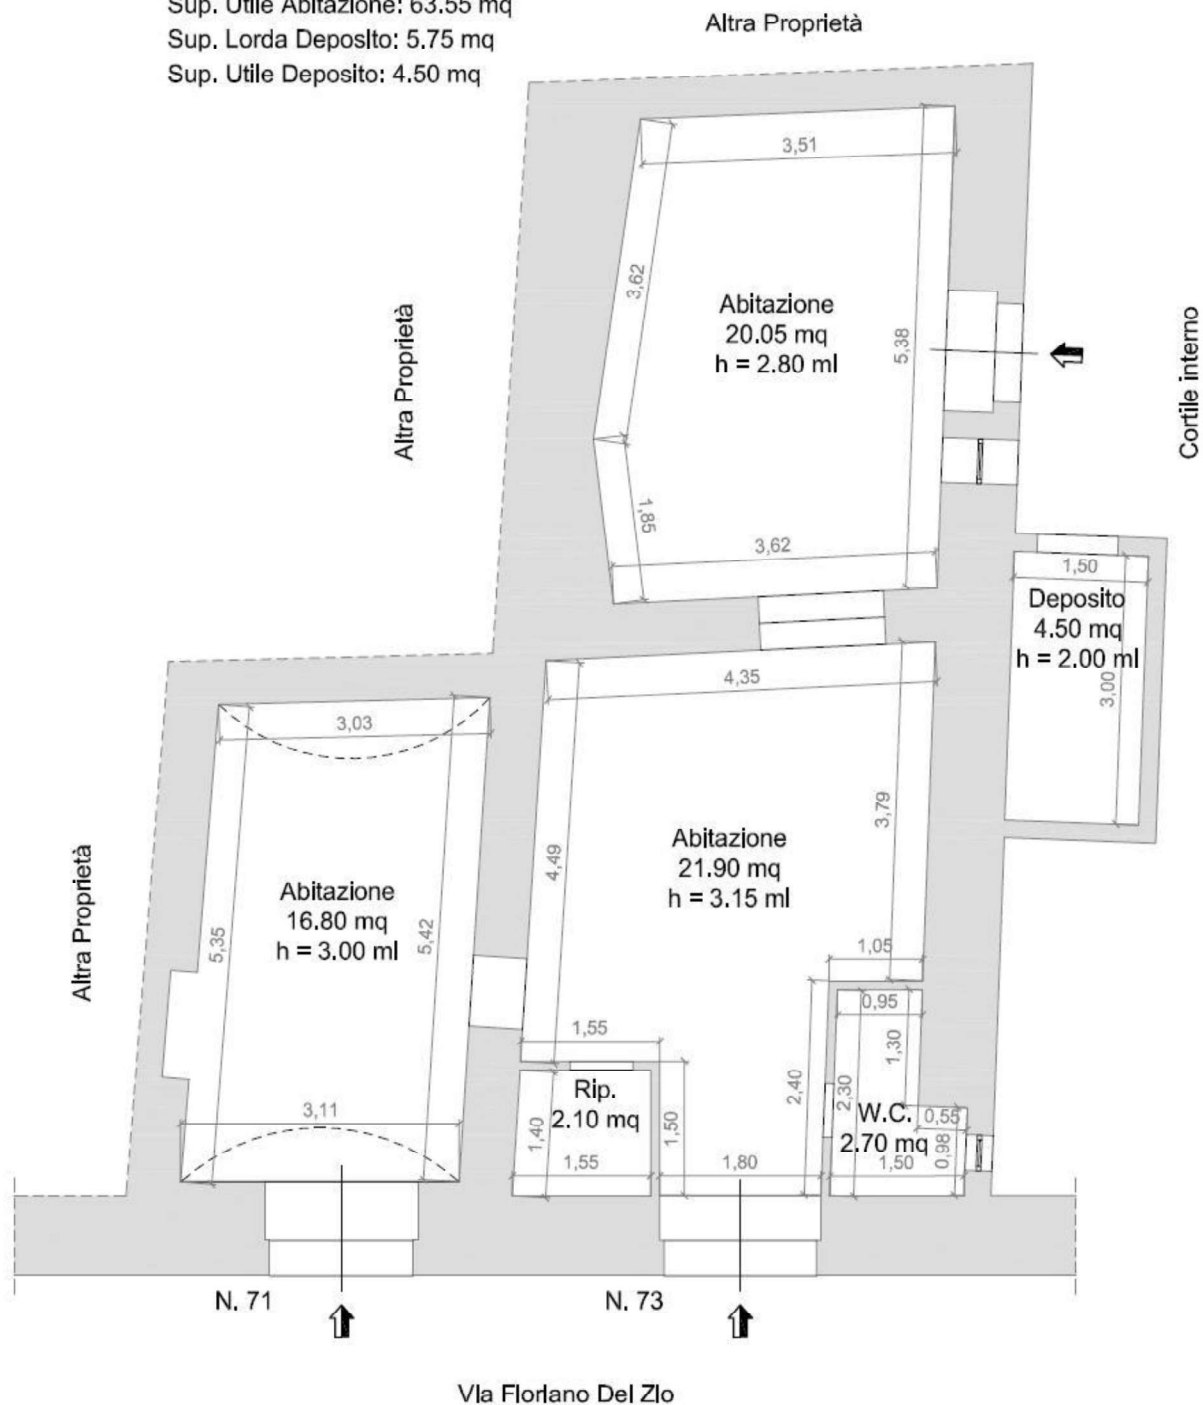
Planimetria Stato di Fatto Abitazione Piano Terra.
